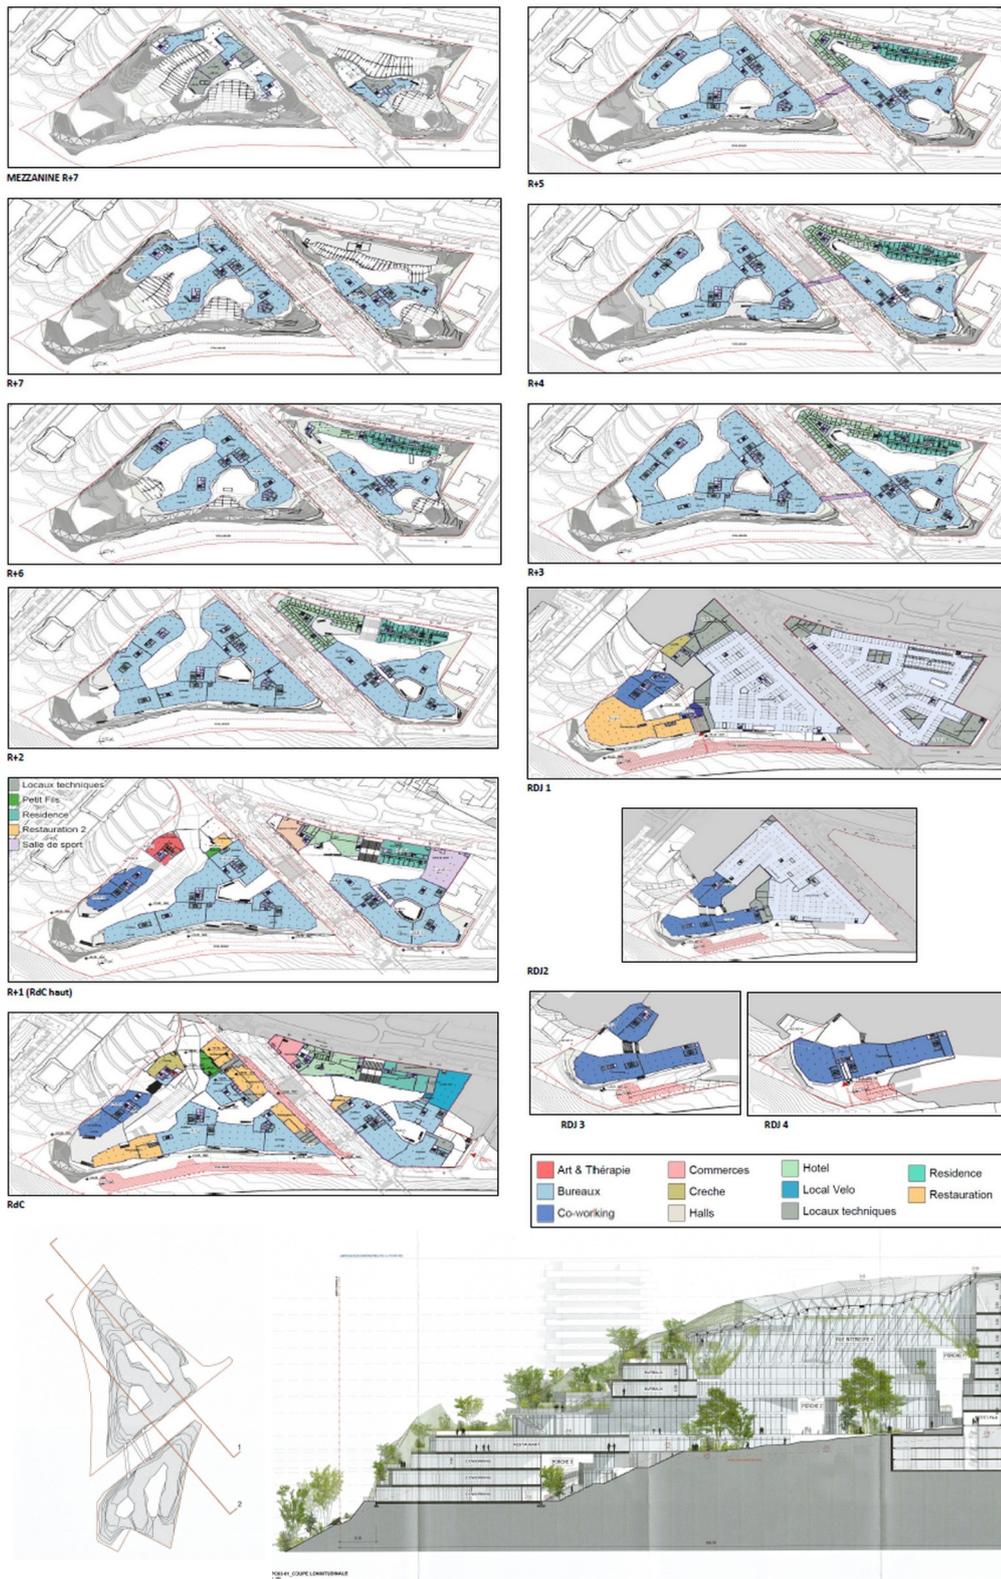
Plans détaillés du projet Écotone (p. 59 et 60) et coupe longitudinale 1 sur le lot 2 (PC 03.01).
